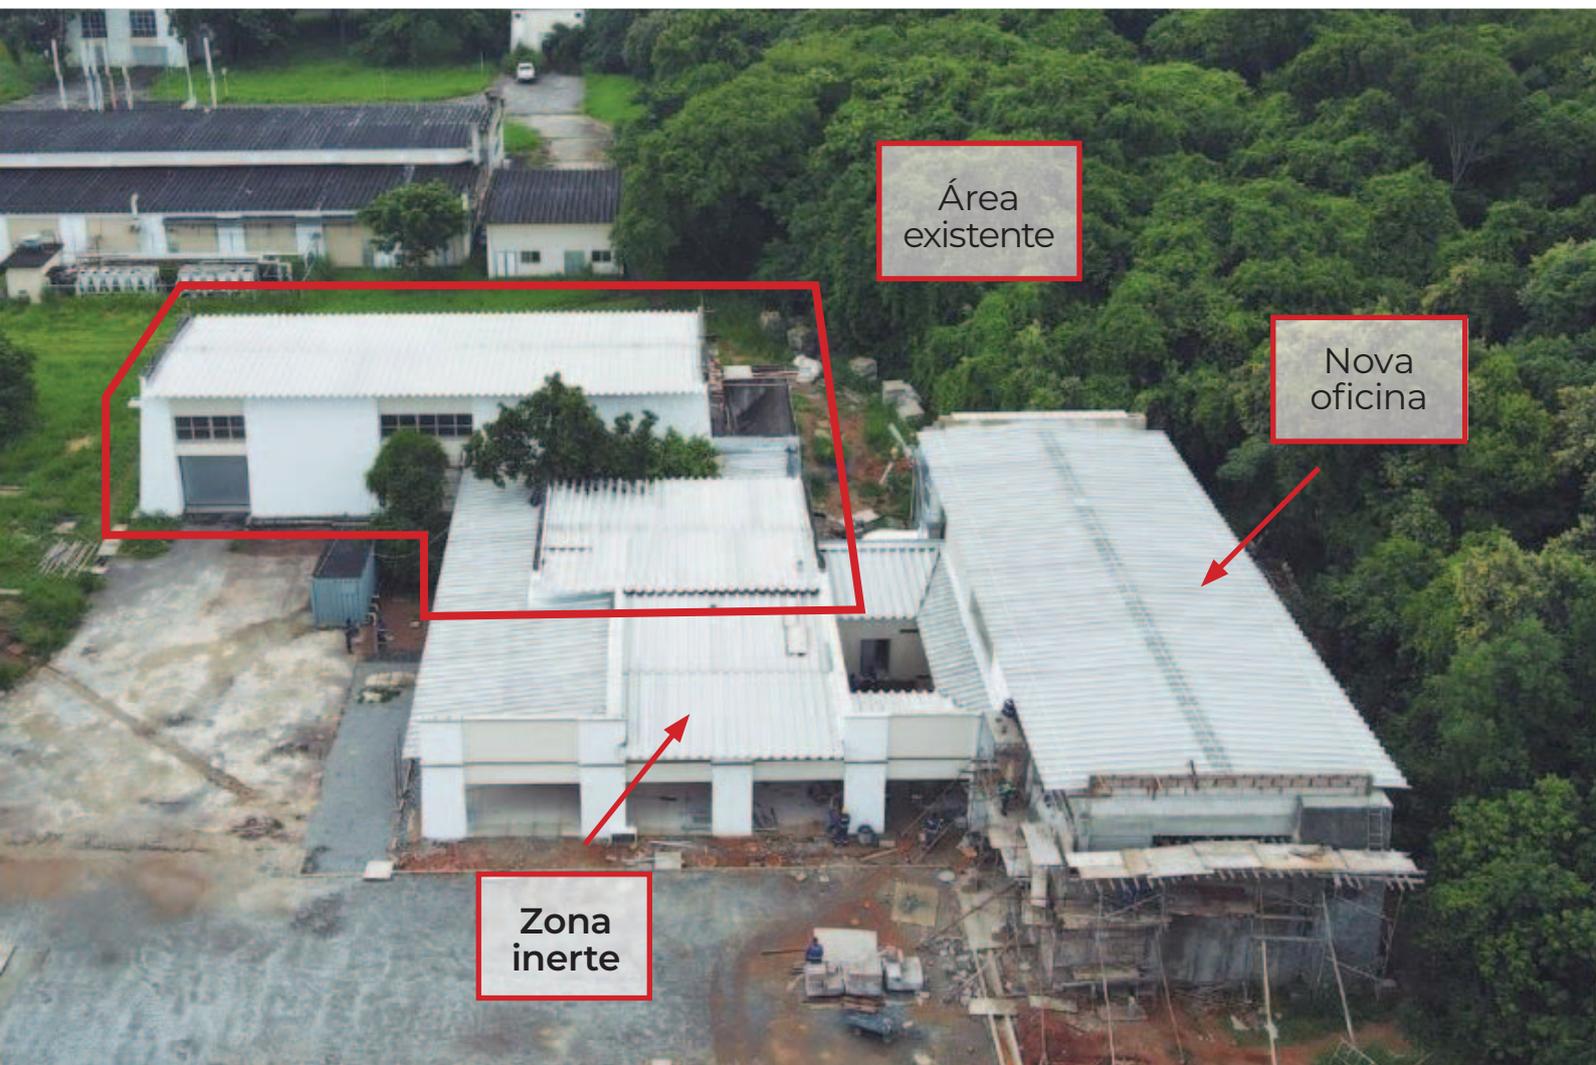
Vista aérea da Oficina Q4 do CMASM durante a construção. Em detalhe, zona inerte, nova oficina e área existente antes da obra.
